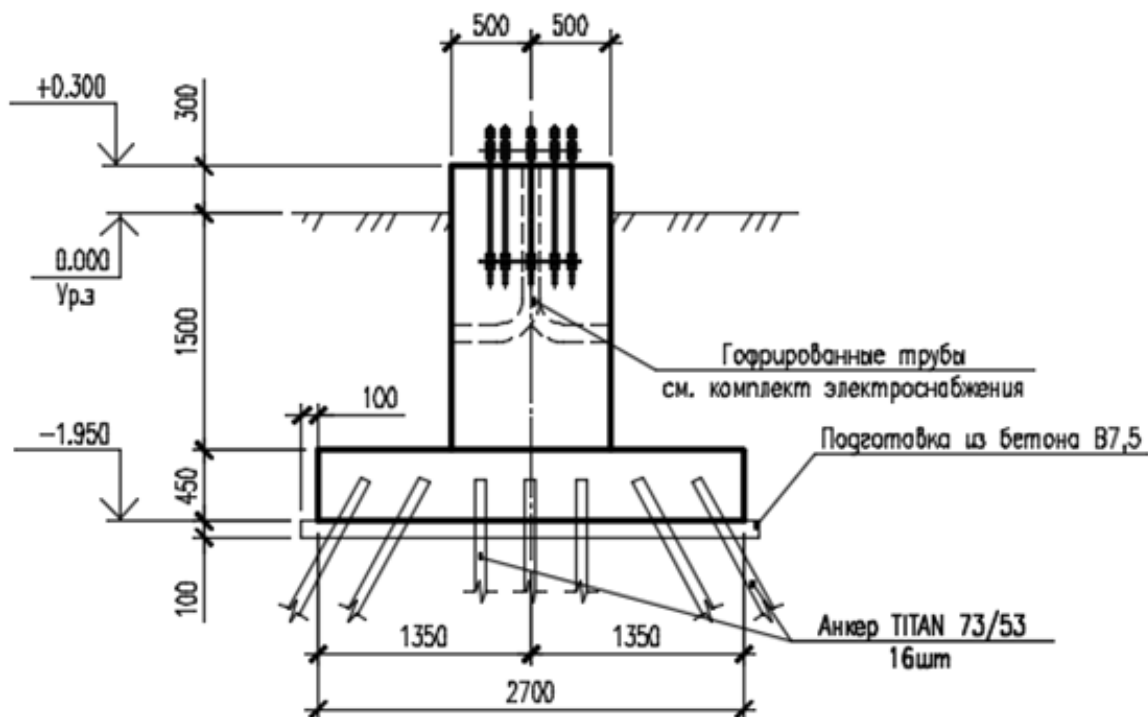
Предложенный вариант свайного фундамента на грунтовых анкерах
